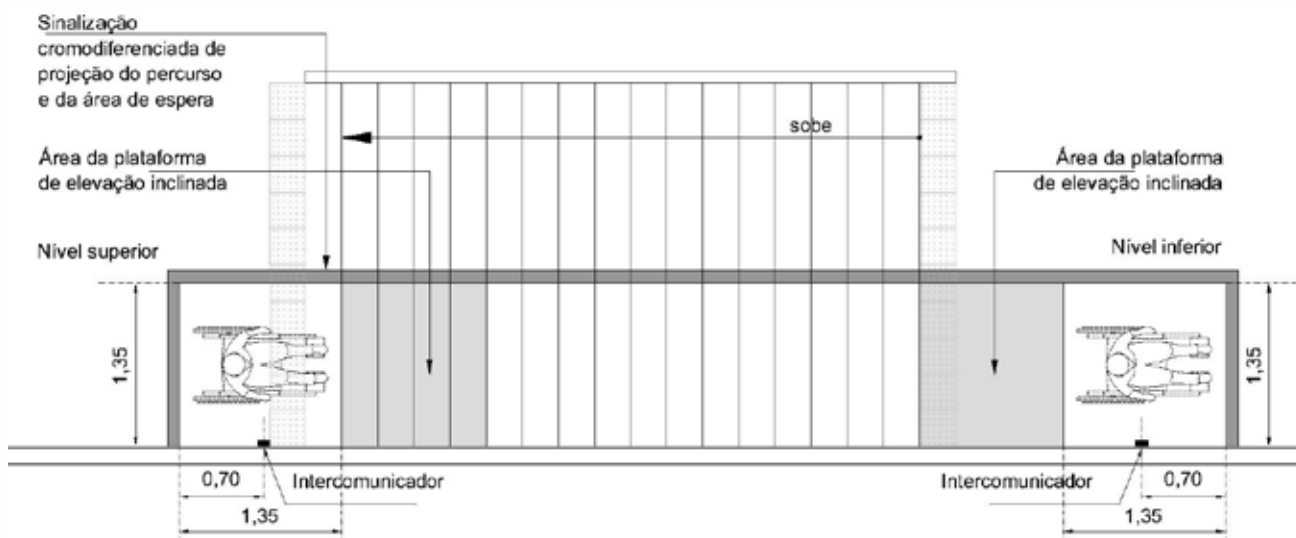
Sinalização de piso junto à plataforma de elevação inclinada – Vista superior
